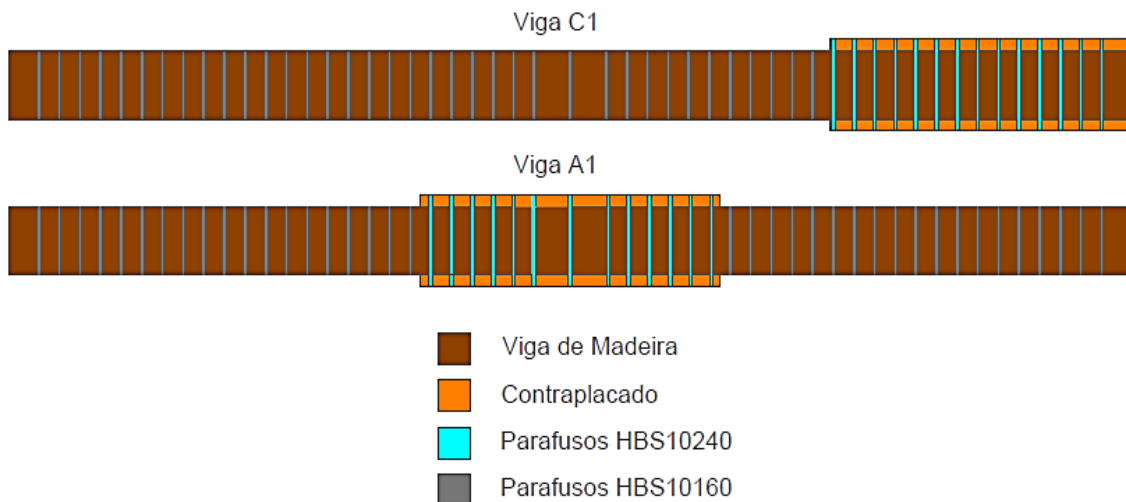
Esquemas de reparação das vigas C1 e A1 (vista longitudinal)
